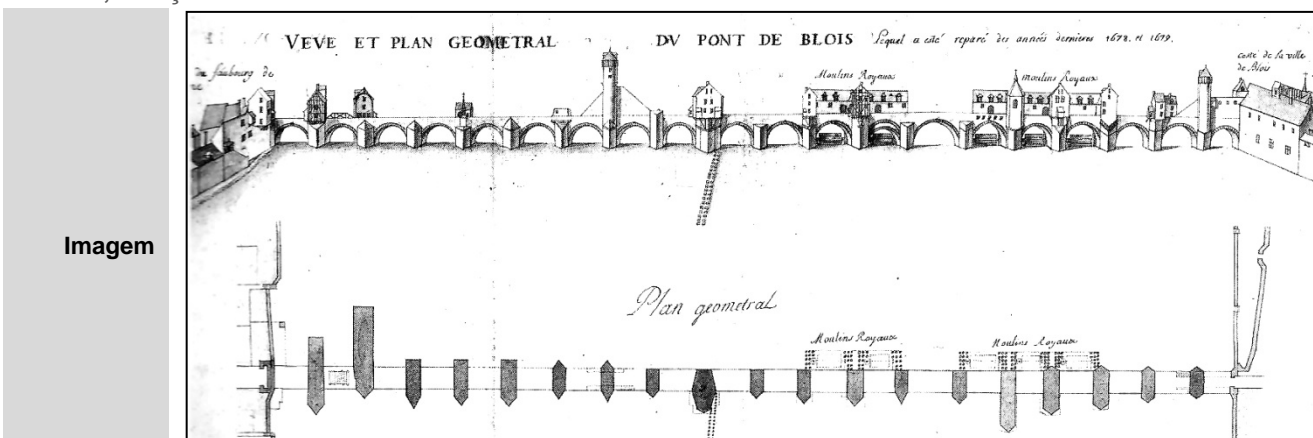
, Nicholas Poictevin, *Planta e vista da ponte de Blois reparada em 1678-79, 1680.
